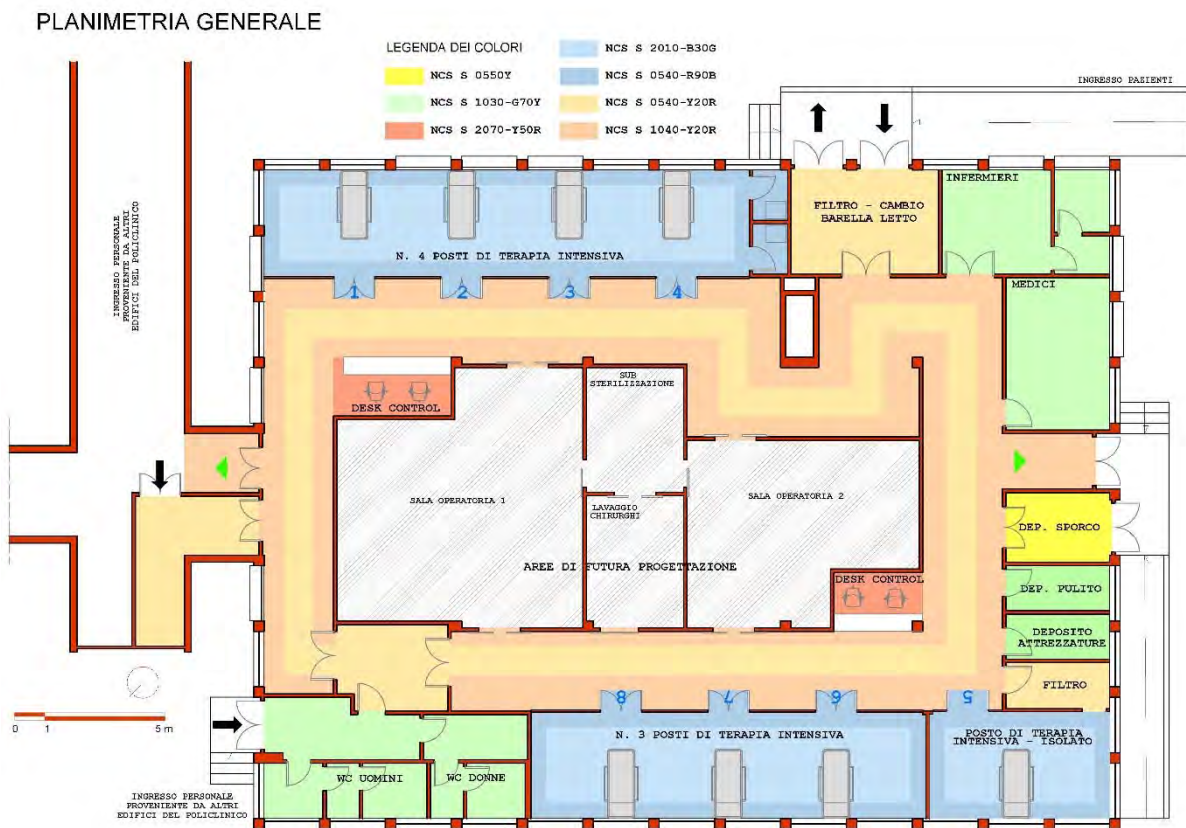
Planimetria di progetto della futura Unità di Terapia Intensiva e ipotesi di umanizzazione con l'uso del colore sui pavimenti.
